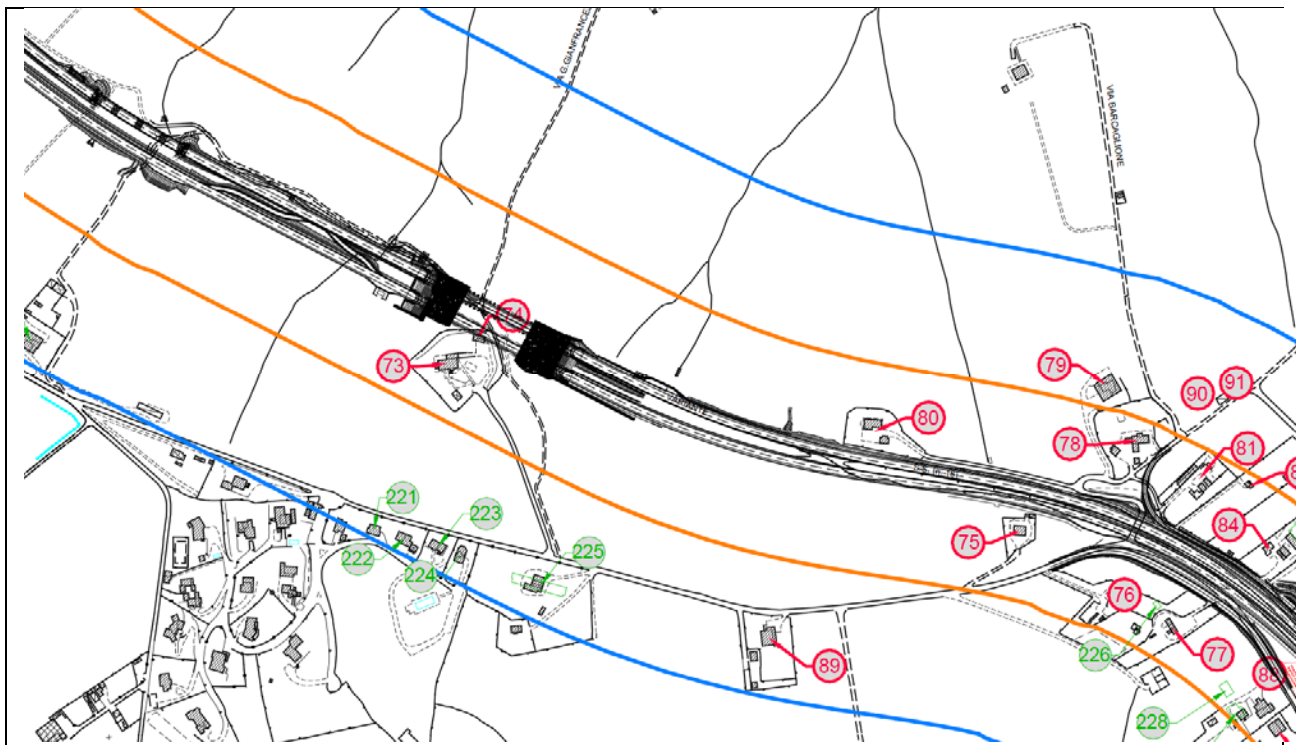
Estratto della planimetria di localizzazione, dei ricettori censiti e della zonizzazione acustica - Tav. 2 - Galleria Orciani
